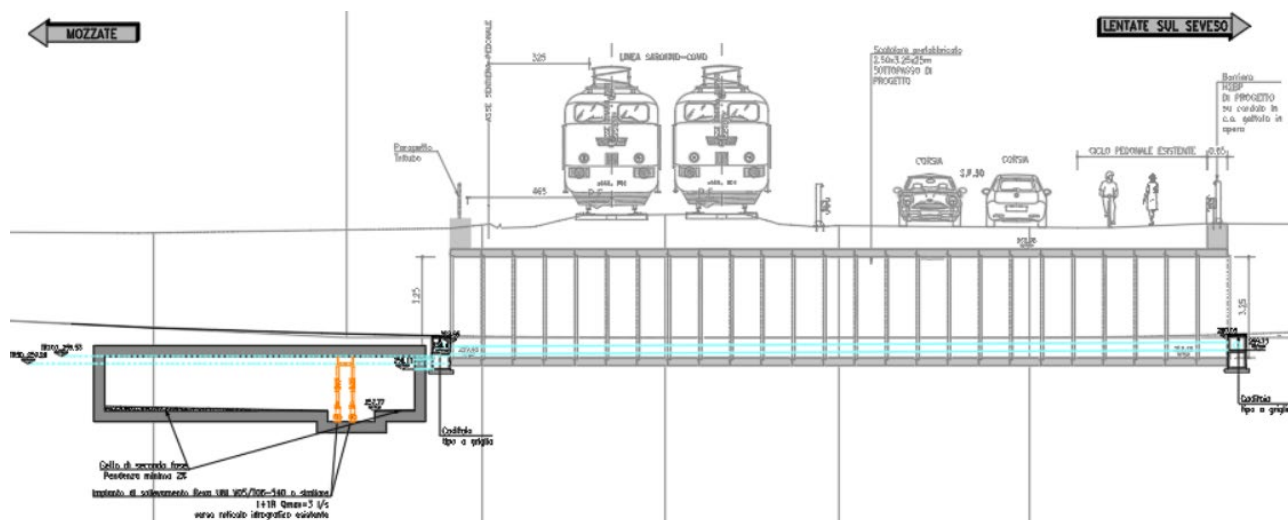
Profilo longitudinale del sottopassaggio (vista nord)
